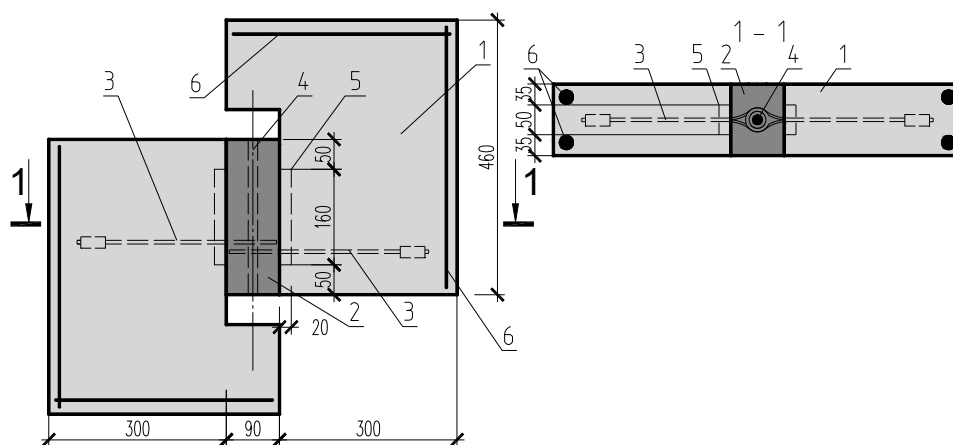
Образцы ЛС: 1 – бетонный элемент; 2 – стык; 3 – тросовые петли «РЕИККО»; 4 – продольный арматурный стержень $\varnothing 16$ мм; 5 – шпонка; 6 – армирование
